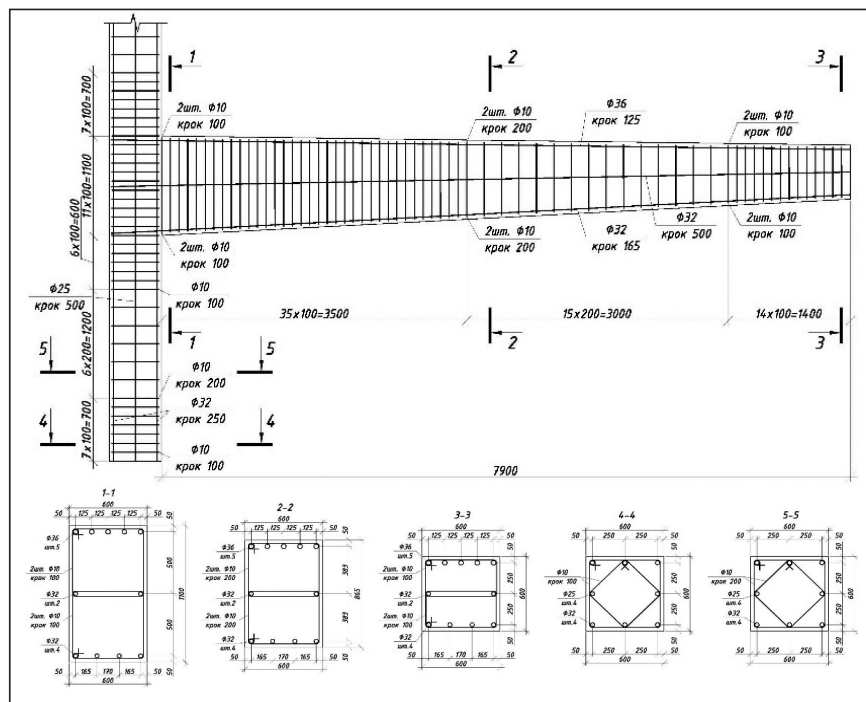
Армування згідно з розрахунком балки (ригеля) та колони поперечника каркасу багатопролітного гаража-стоянки за стрижньовою розрахунковою схемою
